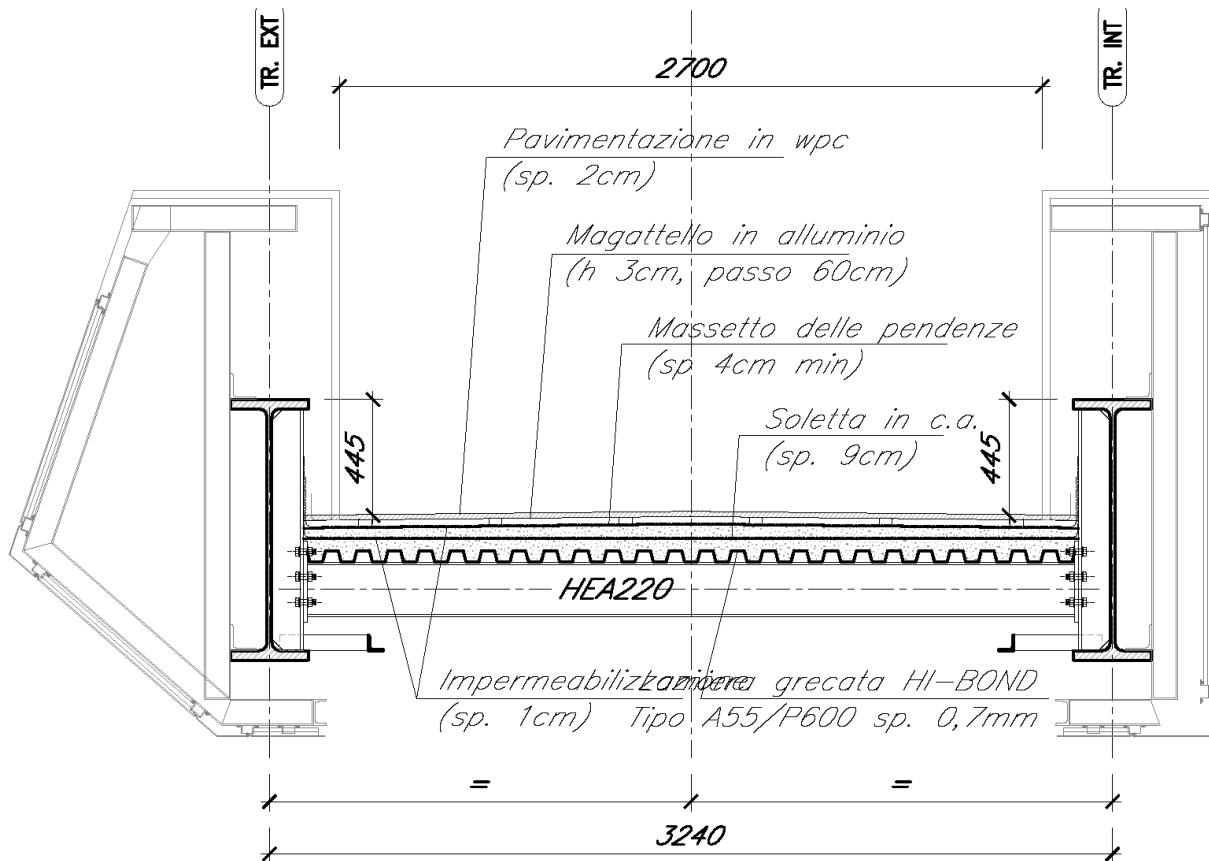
Sezione trasversale dell'impalcato delle rampe [mm]
